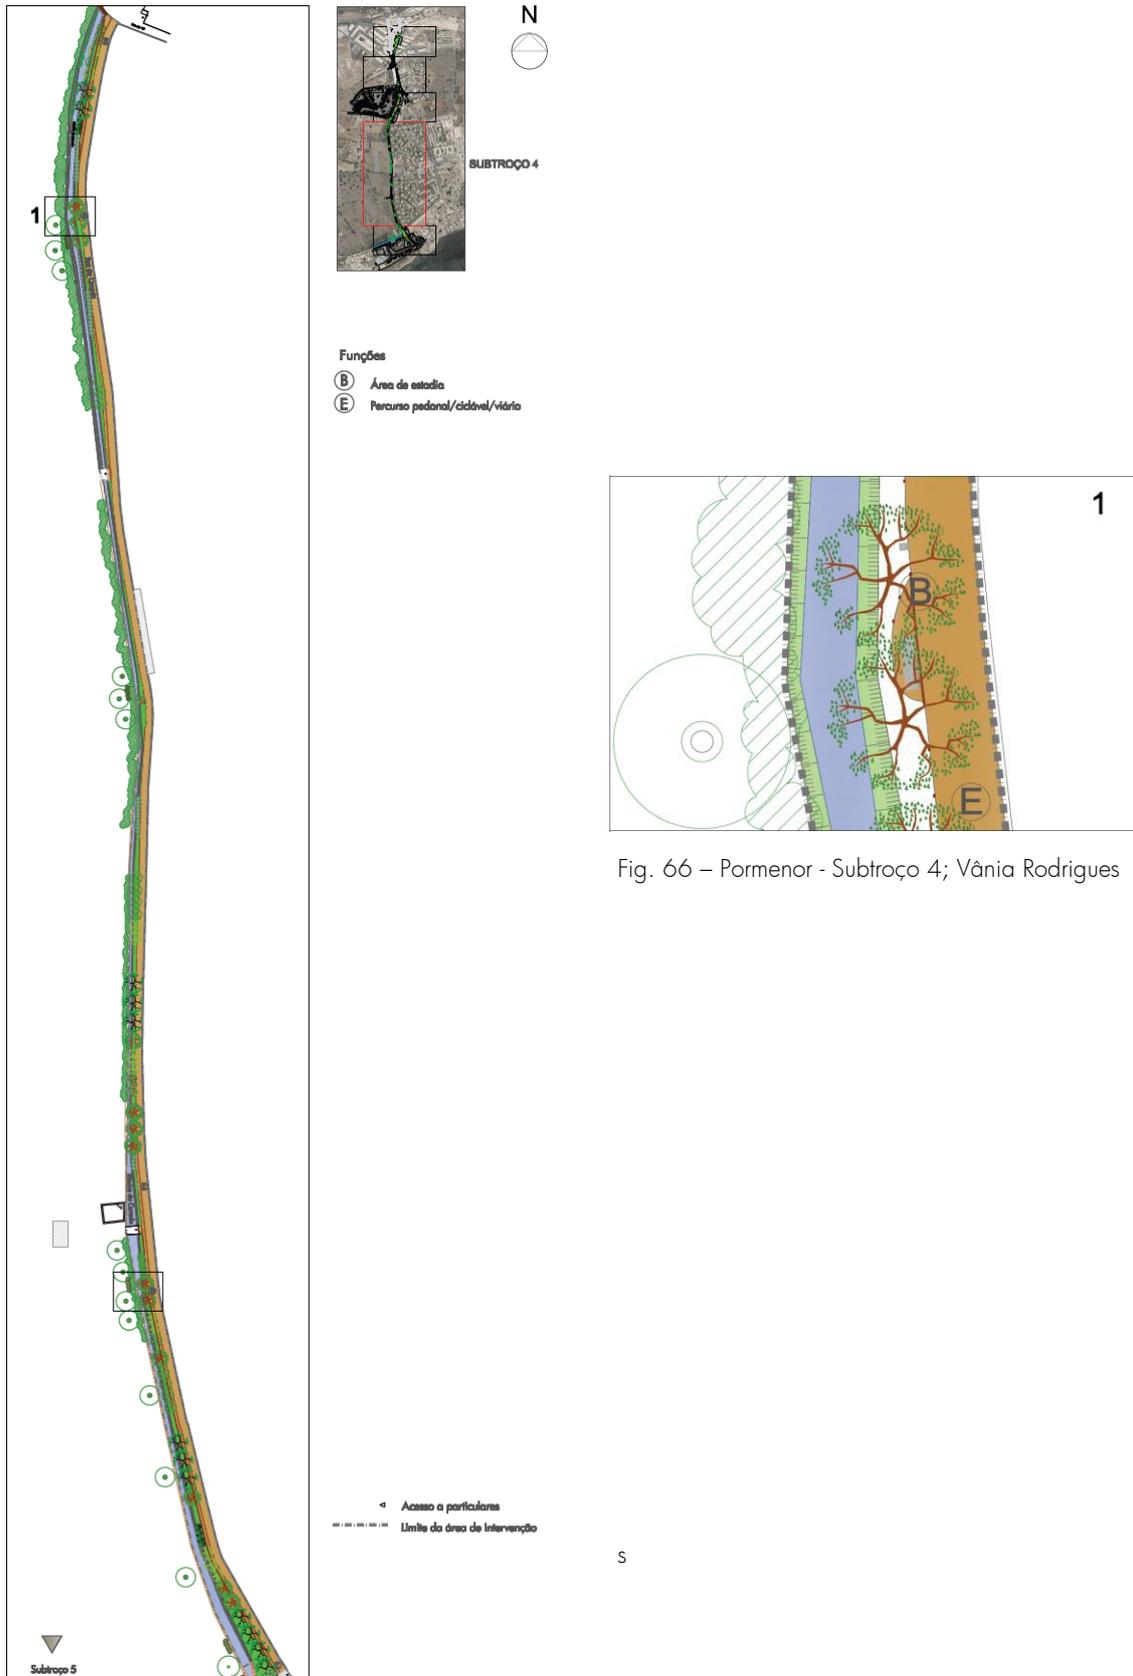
Plano Geral - Subtroço 4; Vânia Rodrigues
